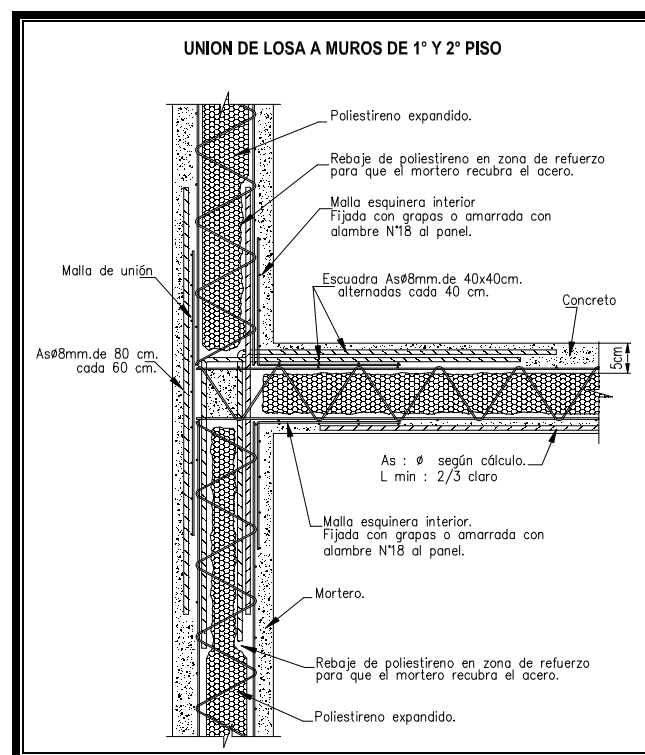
Detalle de armado acero de refuerzo en la unión de muros con losa de entrepiso
